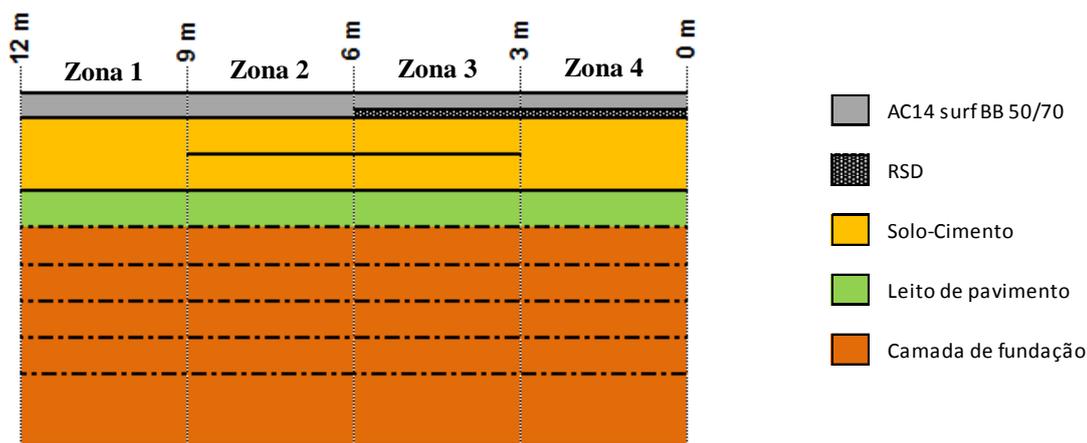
Representação esquemática das soluções de pavimento aplicadas na pista de ensaio
